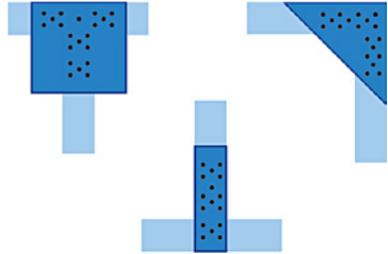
Schichtholzplatten zum Fixieren von Holzelementen (Blockhaus, THW)
